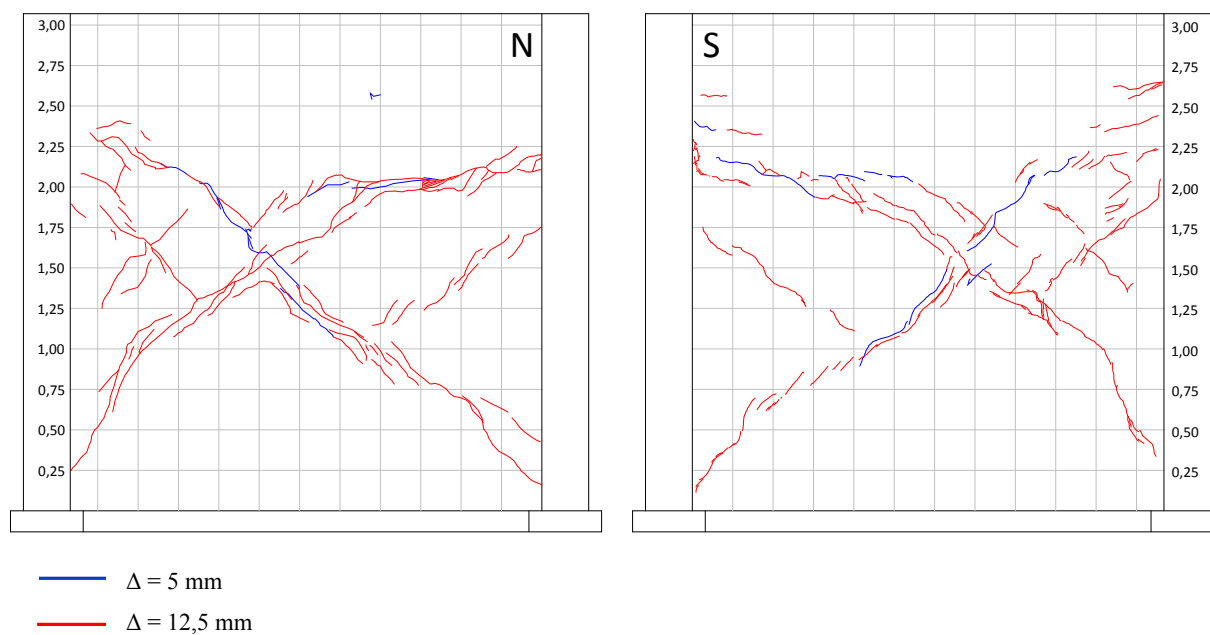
Evolução da fissuração nas faces Norte e Sul.
